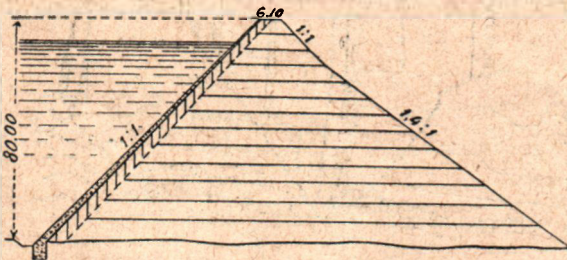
Деталь напорного откоса плотины Стробрери.
